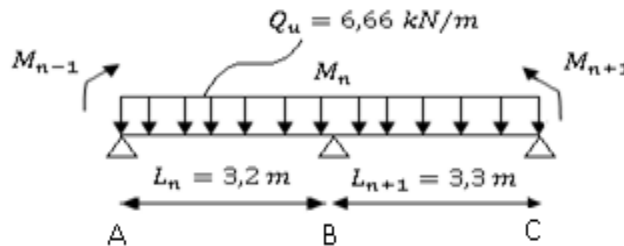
Schéma statique des poutrelles du plancher terrasse.
